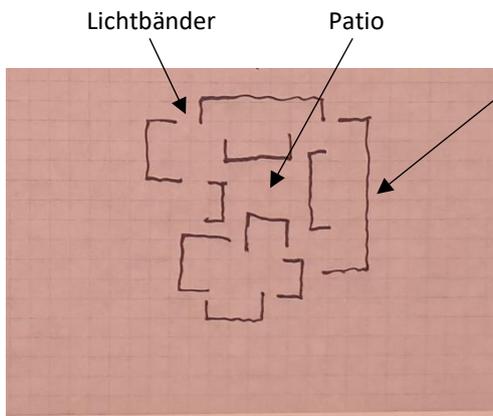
Grundriss Ausstellungsbereich mit zentralem Patio (W. Düttmann, Brücke-Museum)
